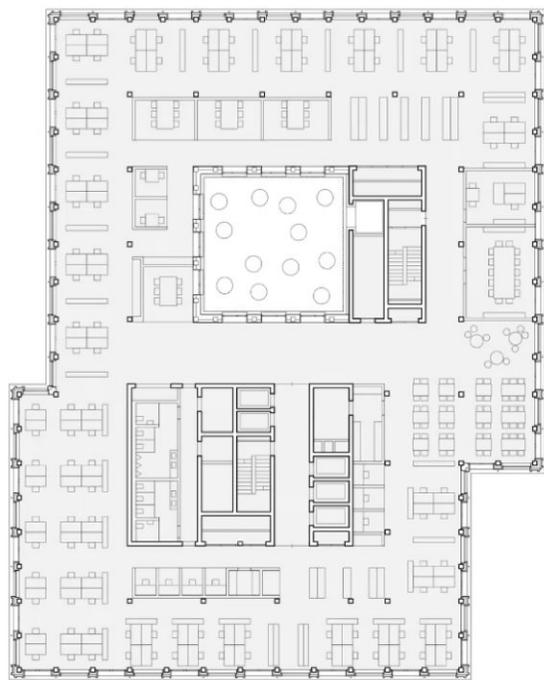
Grundriss, Regelgeschoss, Holzbau, Bürobereich
